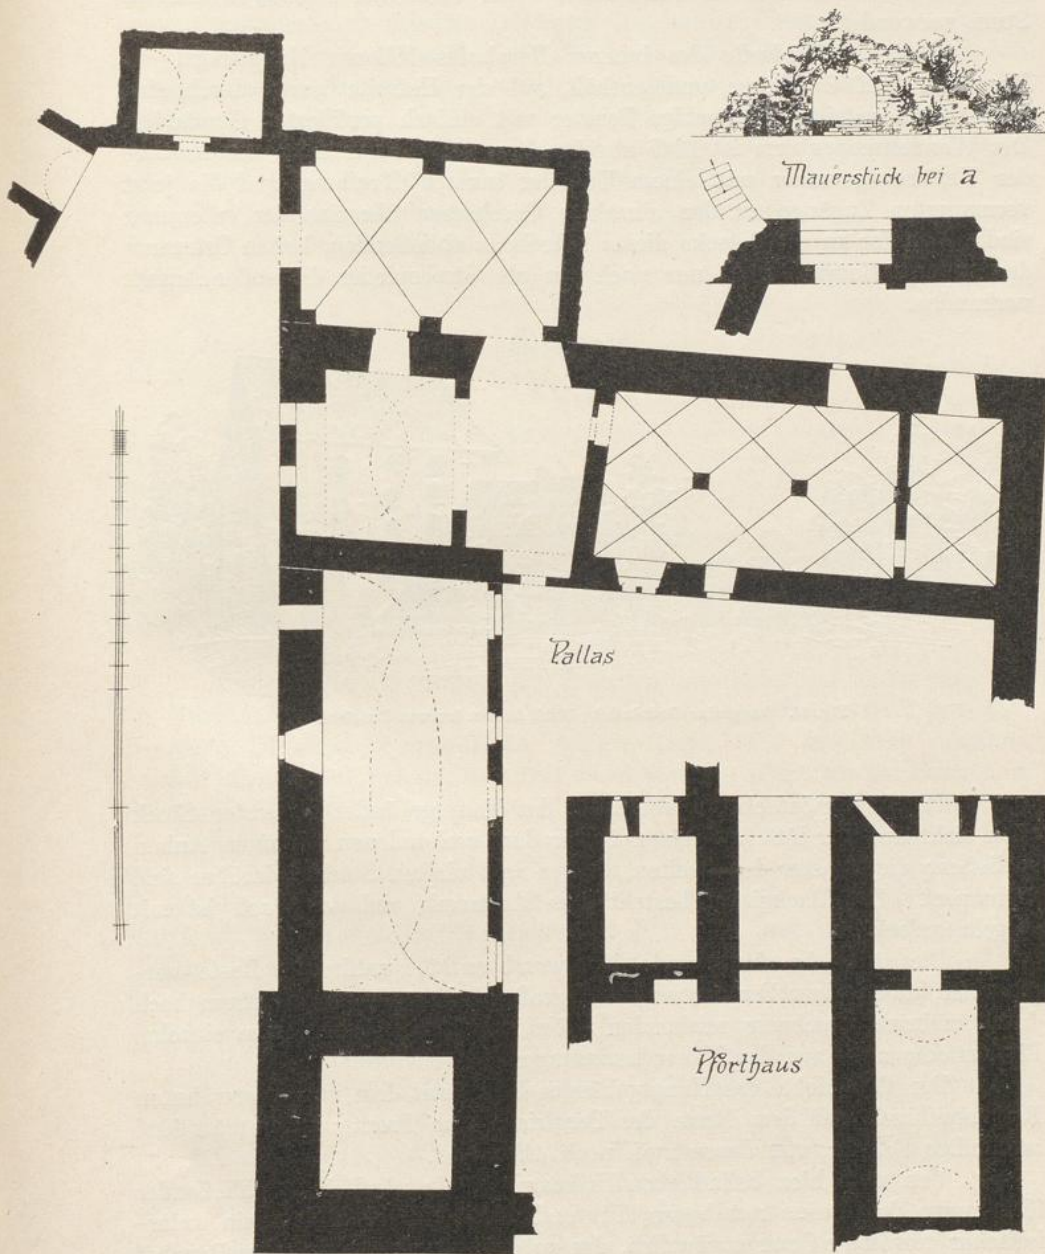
Burgruine Steinbrück; Grundrisse (Maßstab 1:300).
